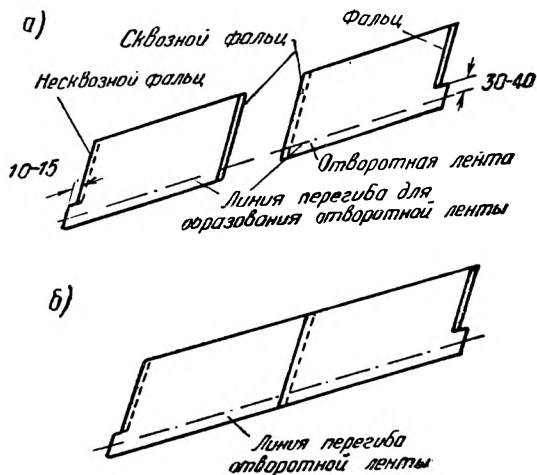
Заготовка картины для покрытия карнизного свеса вразкрой:
